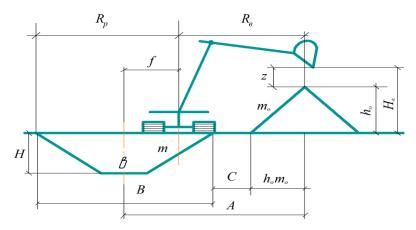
Схема продольно-поперечного способа разработки грунта
